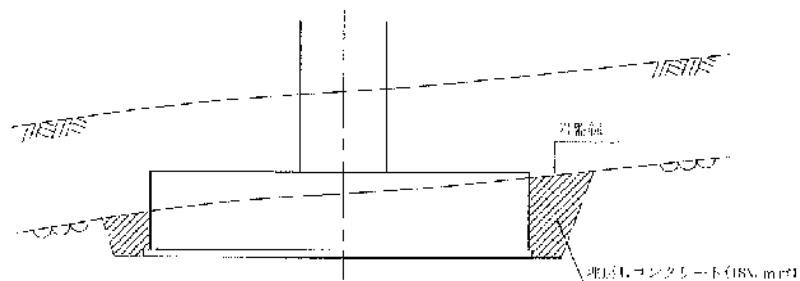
支持層が岩盤の場合の埋戻しコンクリート範囲
